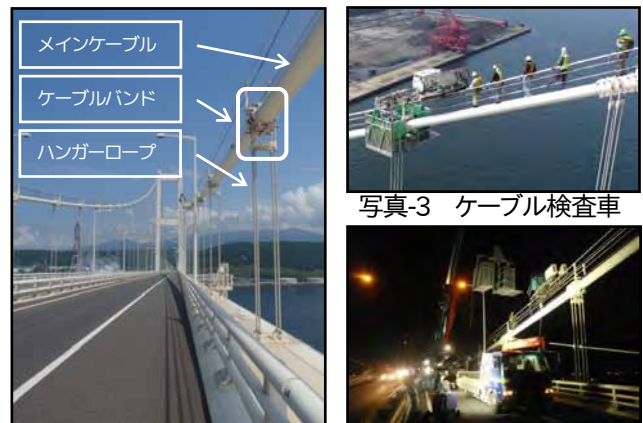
本橋のケーブルバンド 写真-4 検査車架設状況
